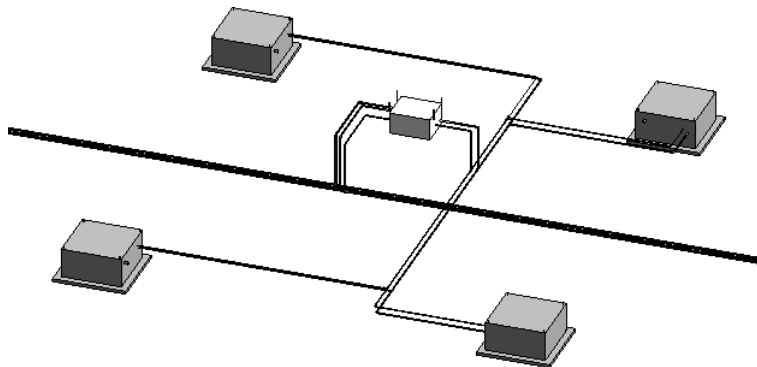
Detalle vista 3D circuito de ventilación planta baja.
